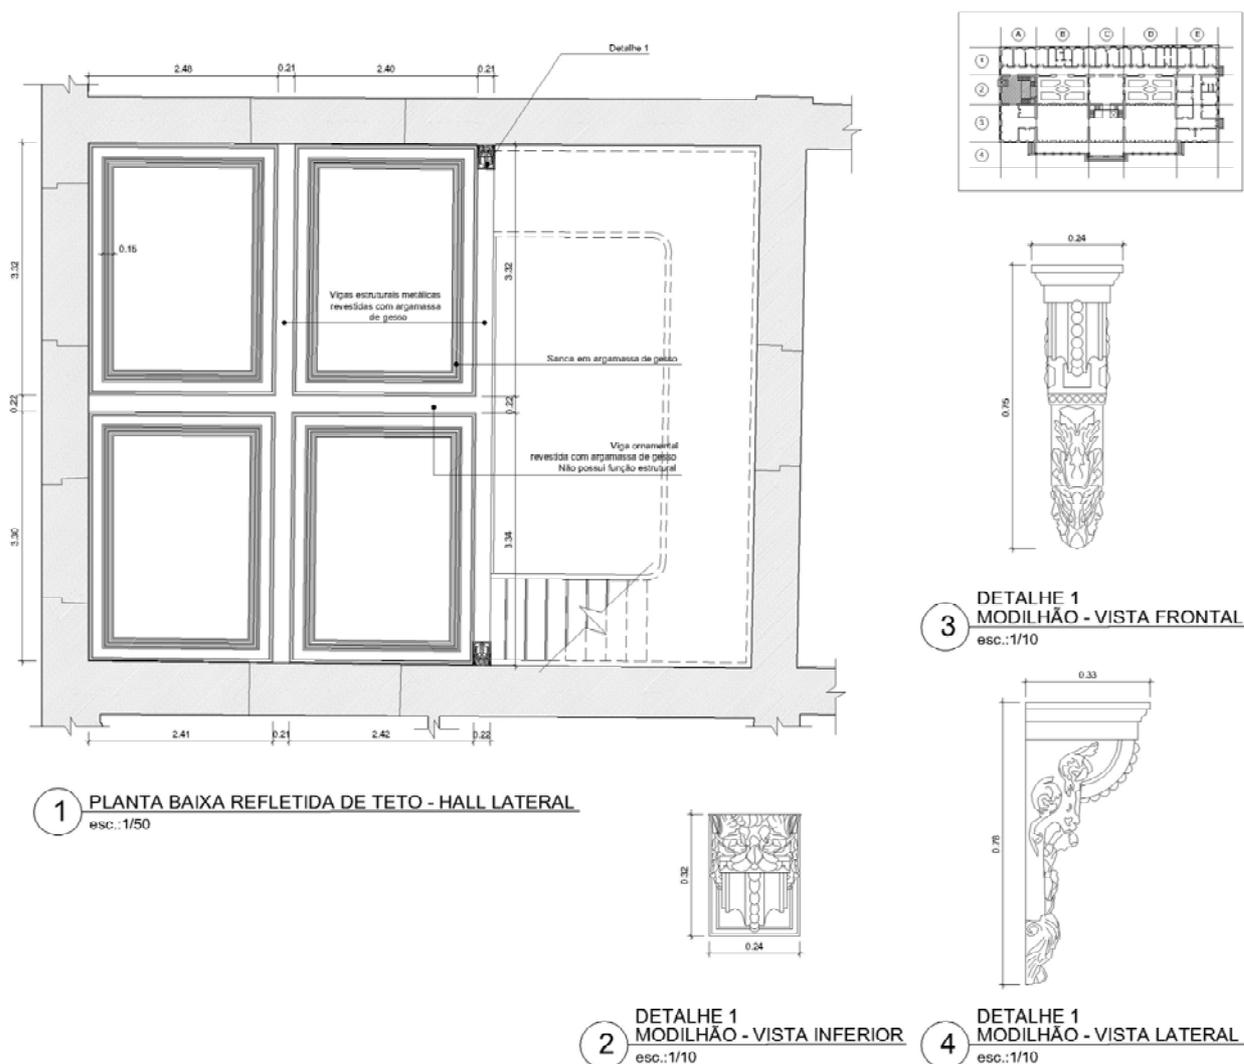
Planta baixa refletida de um teto formado por um forro de estuque ornamentado com frisos e estruturado por vigas de aço cobertas por estuque. As principais cotas estão marcadas e os elementos decorativos foram detalhados. Fonte: Projeto RB762 – UFRJ, 2003.
